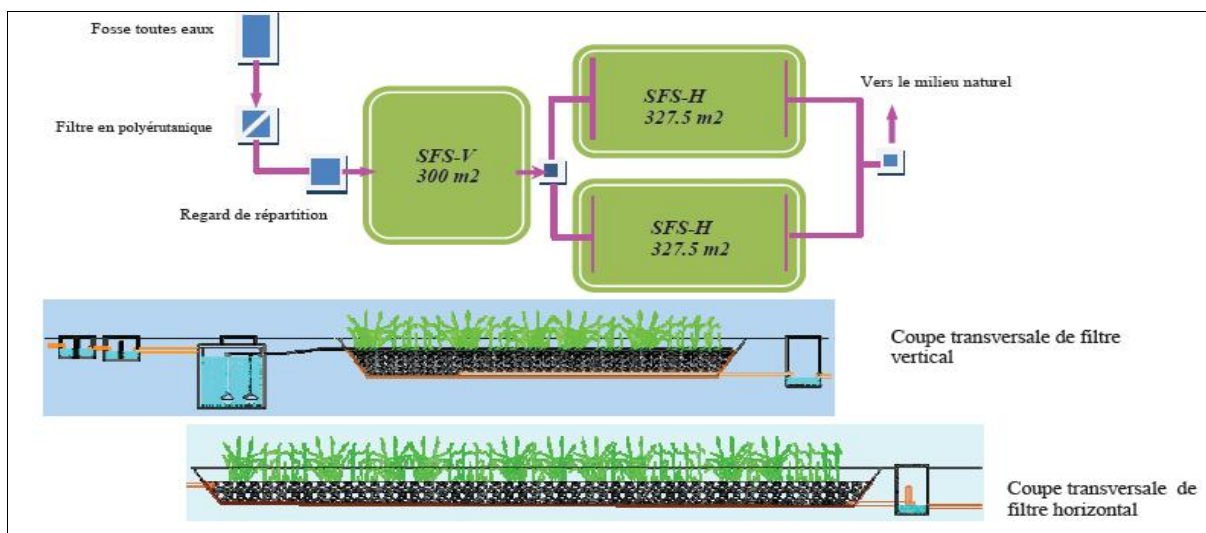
Schéma de l'installation d'un filtre vertical et deux filtres horizontaux de village rouge (2^{ème} variante).
